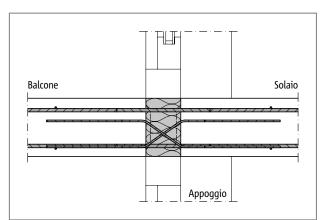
Schöck Isokorb® tipo DXT: sezione costruttiva; solaio piano
